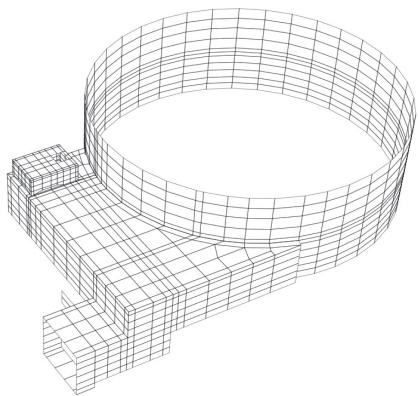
復水貯蔵タンク基礎 三次元モデル図
